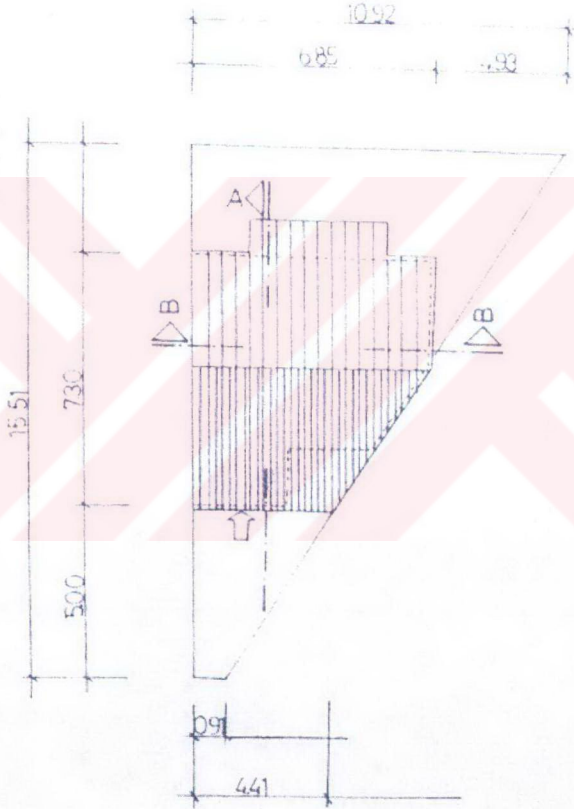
Gecekondu önleme bölgesindeki konutların vaziyet planı
